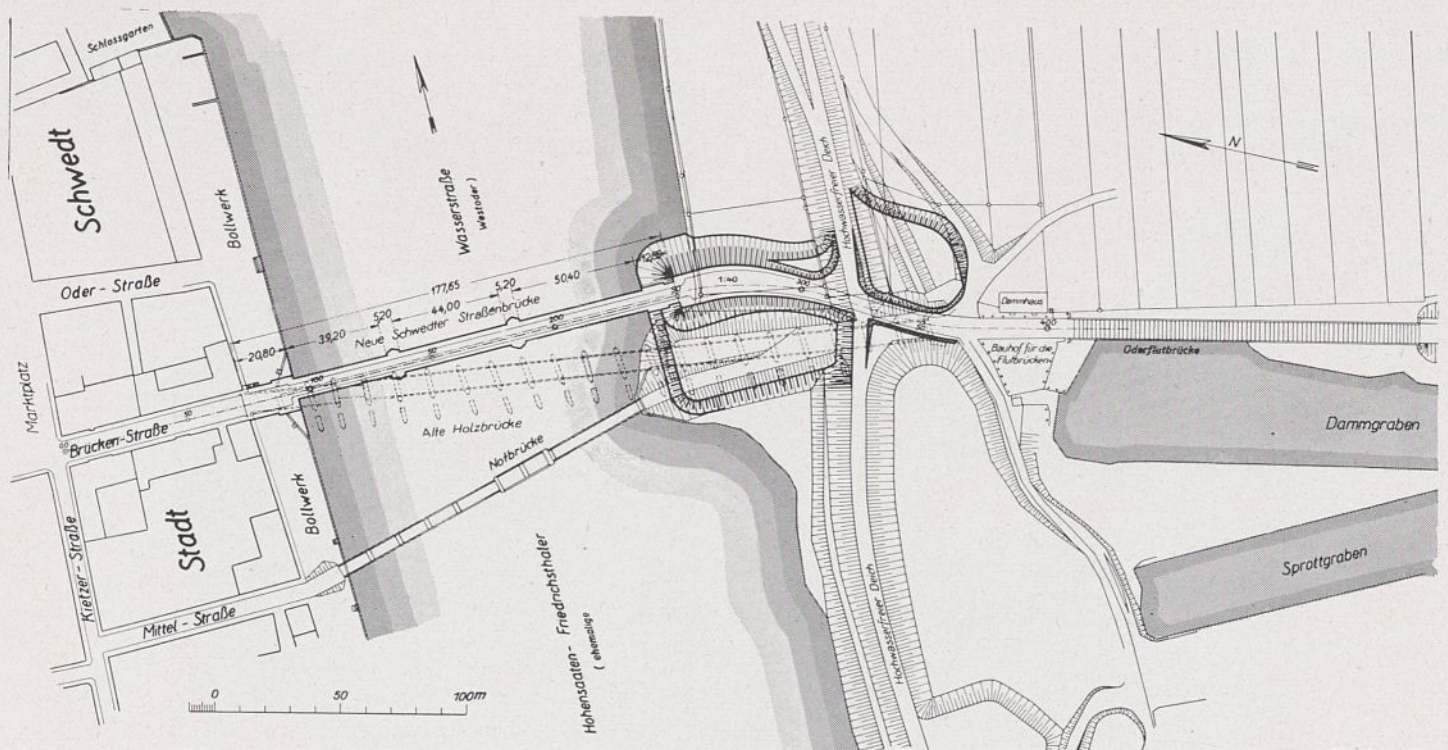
Neubau der Straßenbrücke bei Schwedt, Lageplan. M 1:5000.
